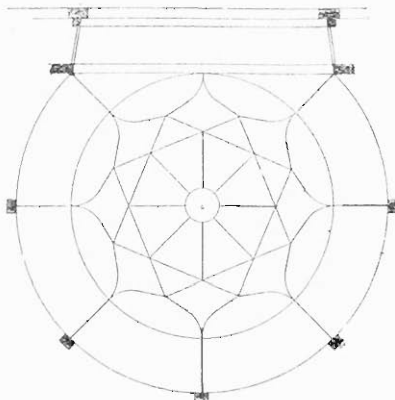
Théâtre Populaire, plan du plafond de la salle.
